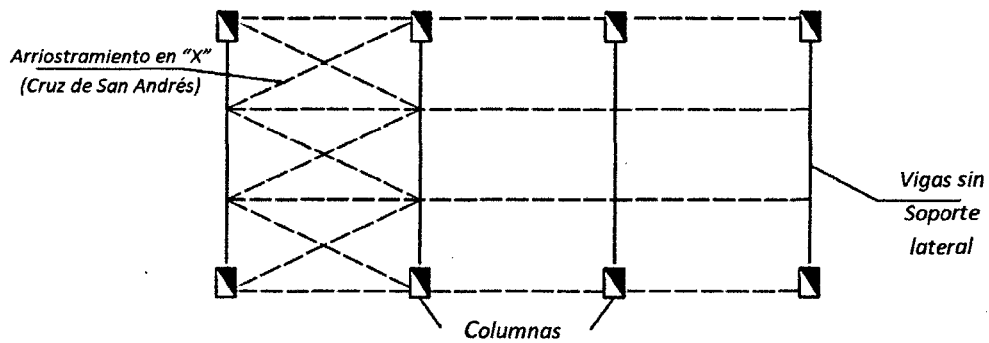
32: Vista en planta de un sistema de vigas arriostradas contra el pandeo lateral.
